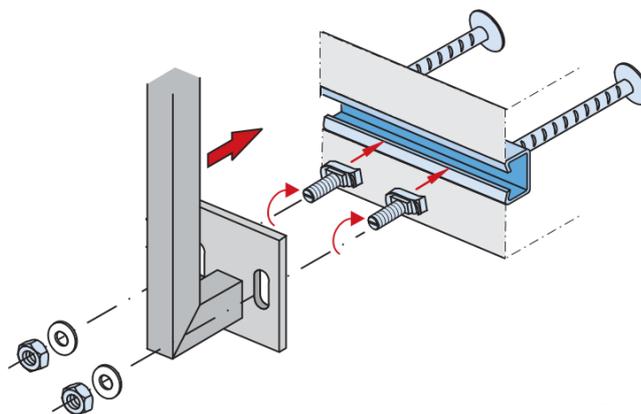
Montage einer Geländerbefestigung nach [14]
